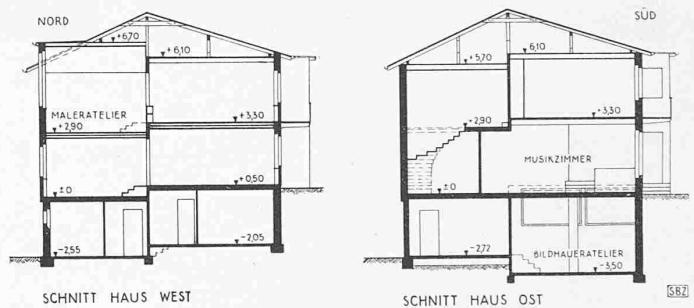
Querschnitte senkrecht zur Dachfirst. — 1:300
